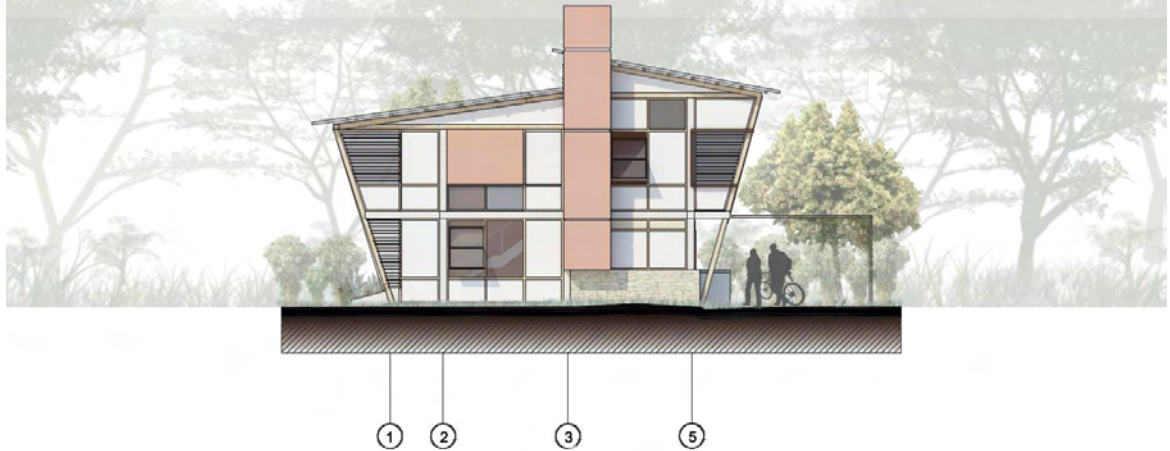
Fachada 03. Alzado Sur AI Fuente: propia
